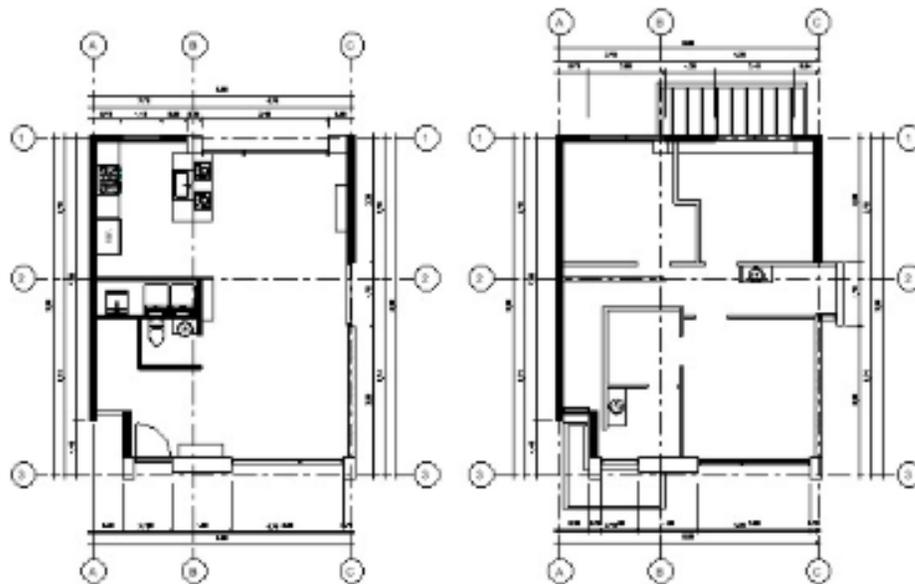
Planos Constructivos Proyecto Paseo Real
